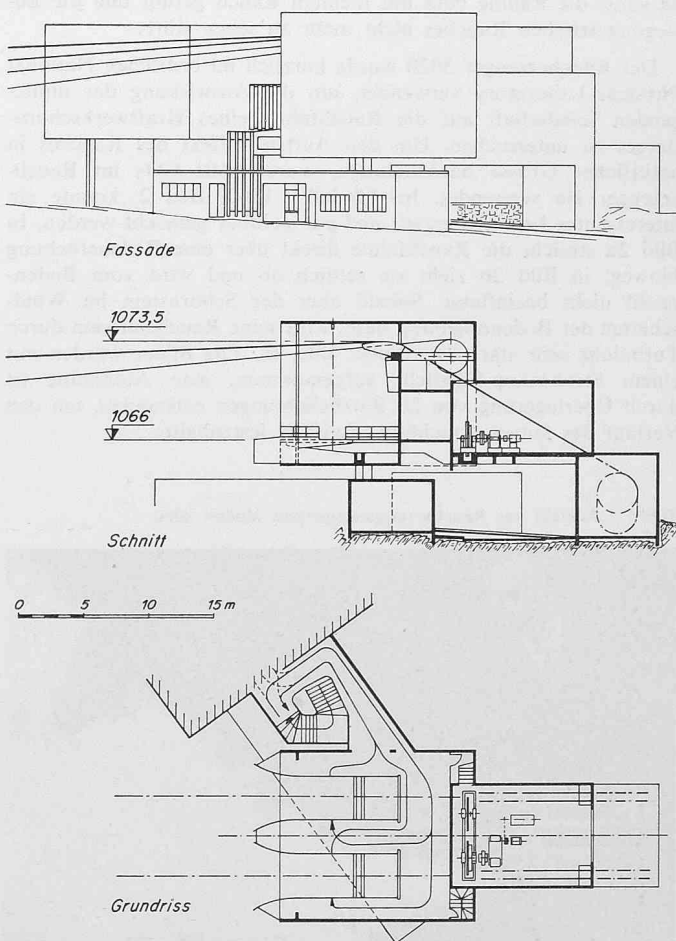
Ansicht, Längsschnitt und Grundriss der Mittelstation nach Bild 7
